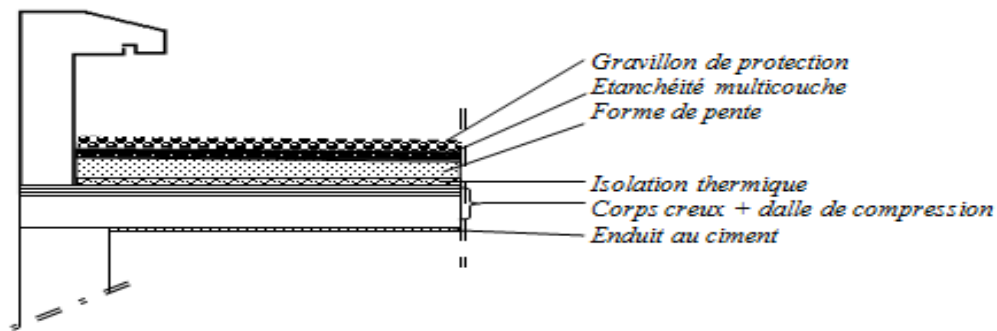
Coupe transversale d'un plancher terrasse inaccessible.
